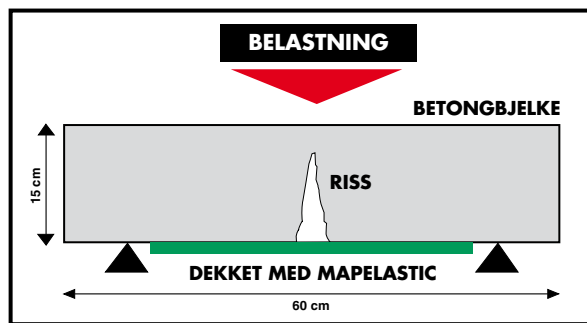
Mapelastic påført over hårriss på undersiden av betongbjelke utsatt for nedbøyning
